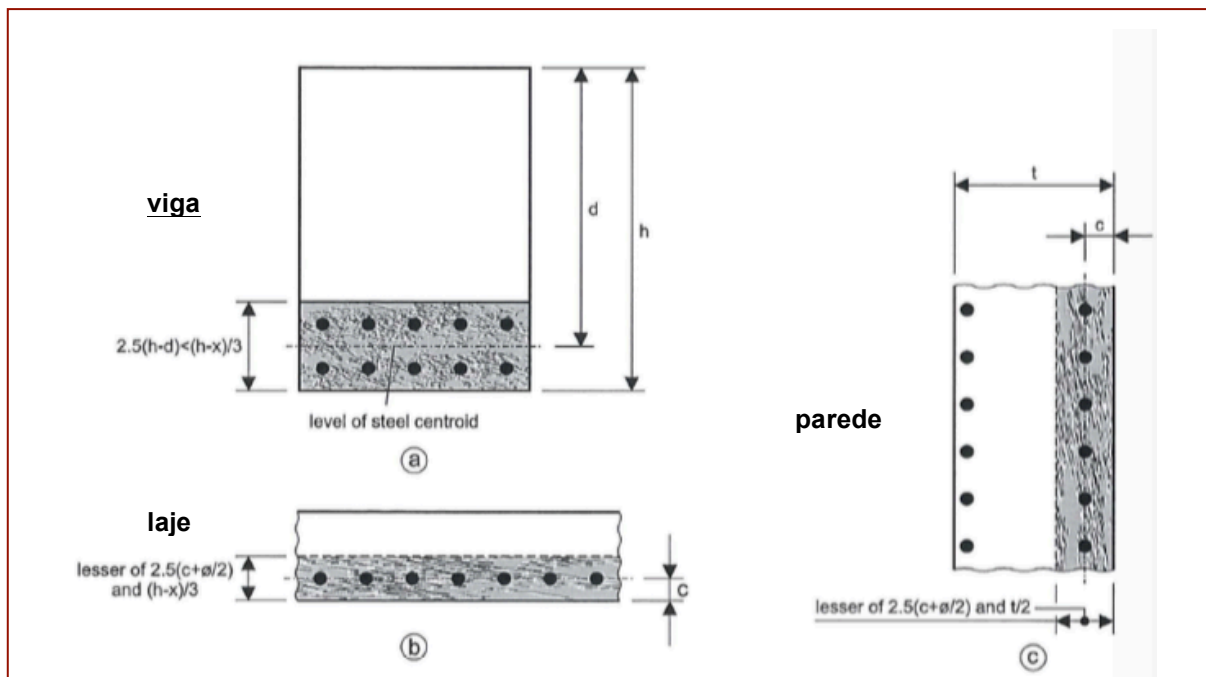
C\~alculo das \~areas efectivas em vigas, lajes e paredes de bet\~ao armado [6].
